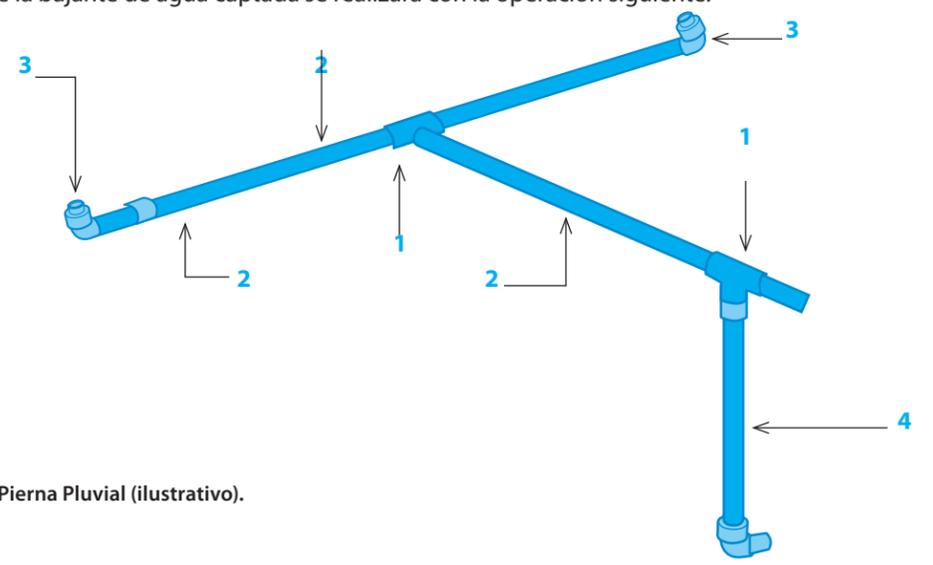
Bajante y Pierna Pluvial (ilustrativo).
